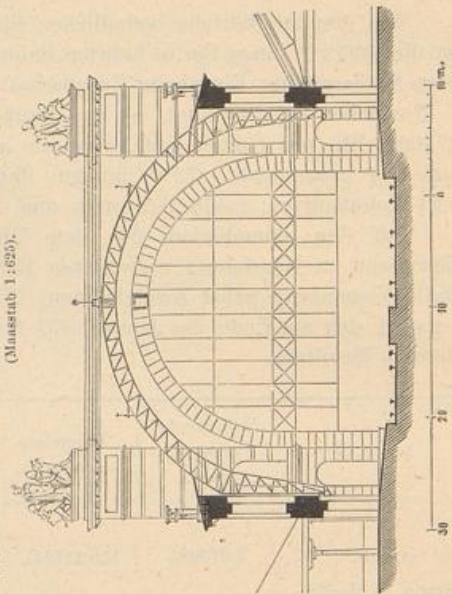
und 66. Empfangsgebäude der Berlin-Lehrter-Eisenbahn. Hauptfacade und Querschnitt durch die Halle. (Maassstab 1:6250).
